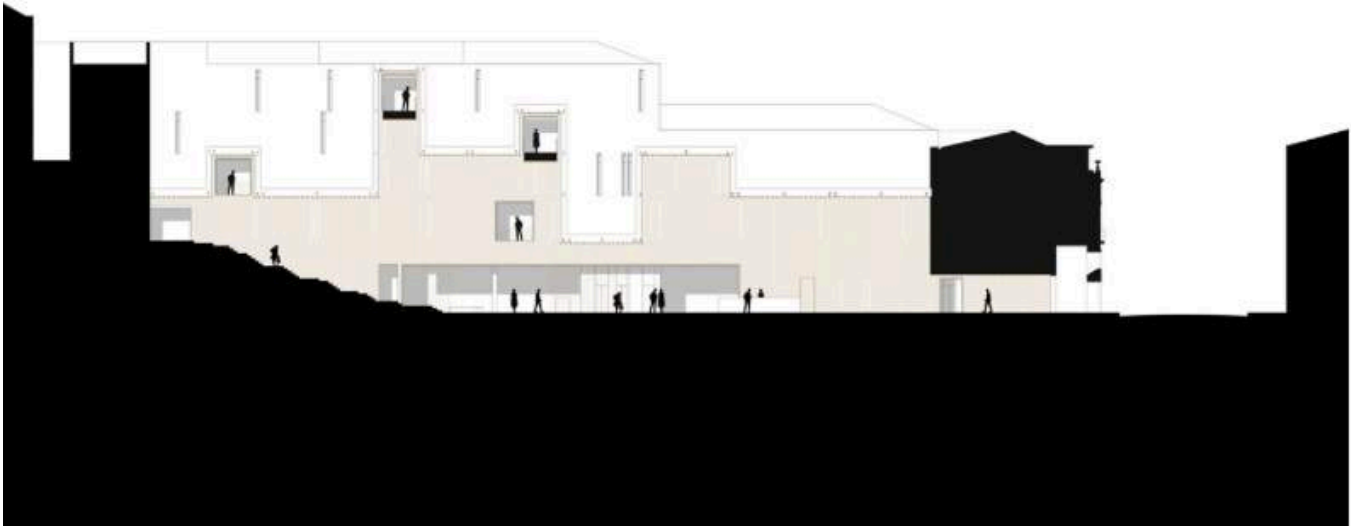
Fachada lateral do Inspira Santa Marta Hotel, sem escala
